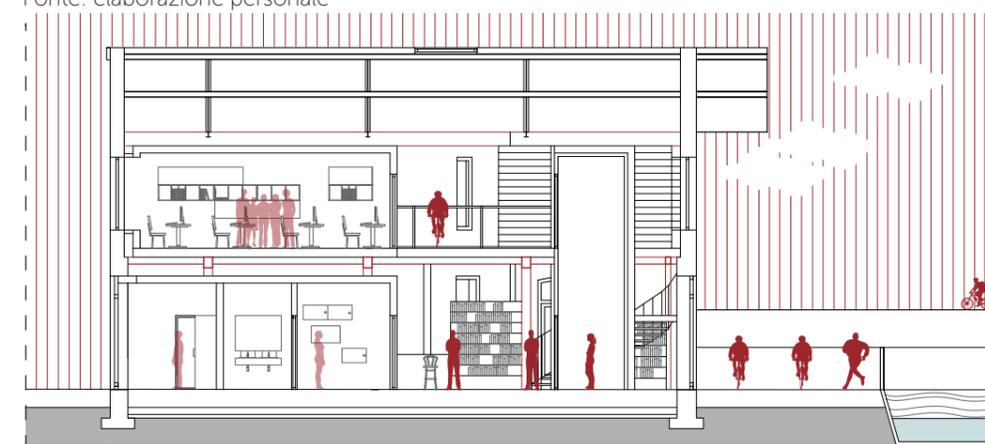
Sezione D-D - scala di dettaglio 1:100
